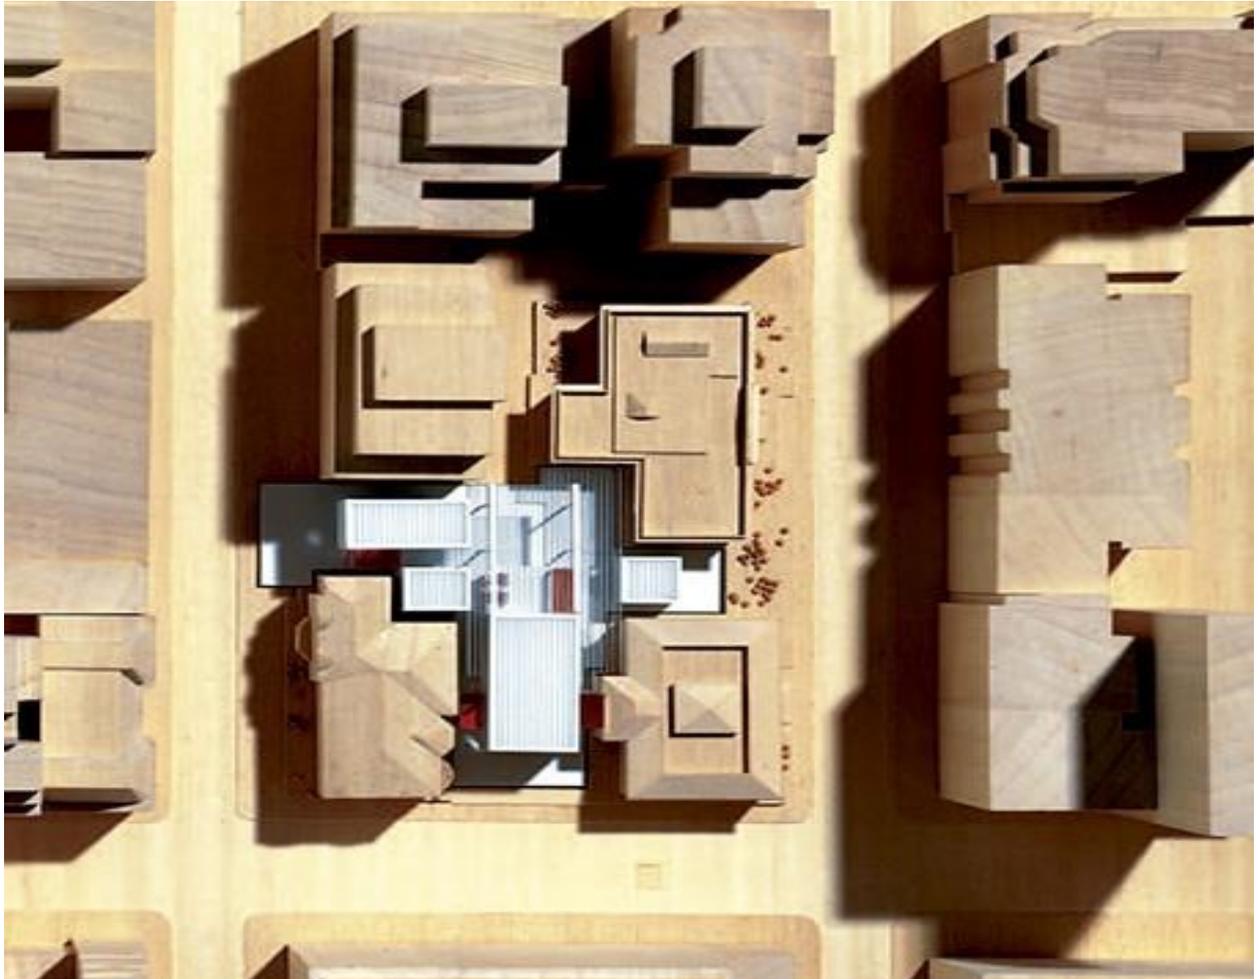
Maqueta del proyecto. Fuente: <https://arquitecturaviva.com/obras/ampliacion-de-la-biblioteca-morgan-nueva-york>.
